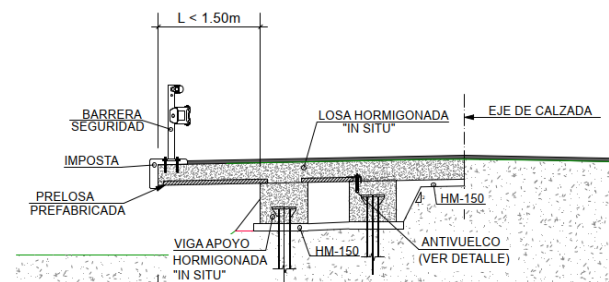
Voladizo de losa < 1,5 m con doble zuncho y micropilotes.
